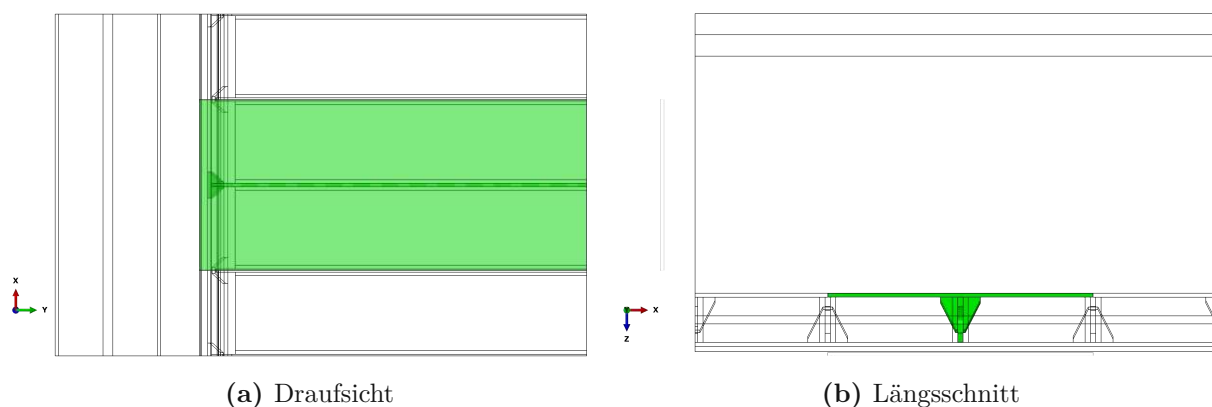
T-Querschnitt oben: (a) Draufsicht (b) Längsschnitt
